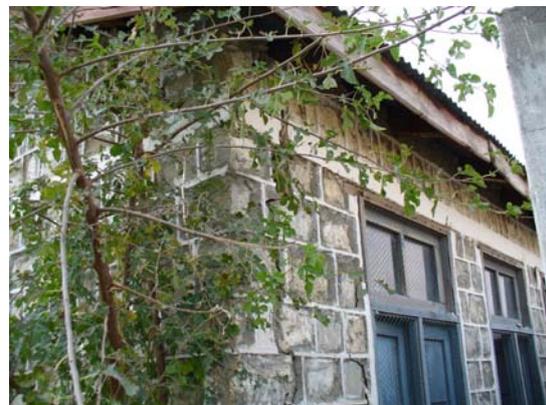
州立小学校壁隅角部のひび割れ
